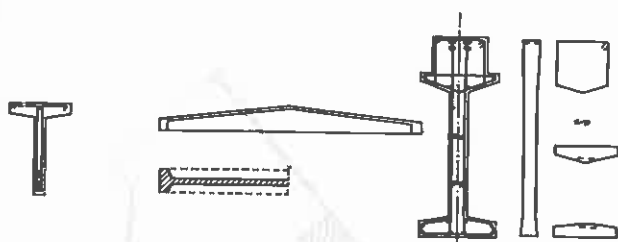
Pormenores de armaduras em vigas de inércia variável (4)
